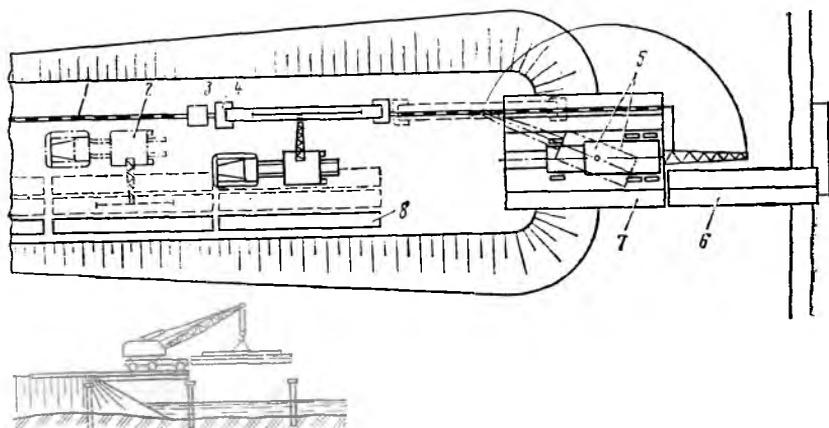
Схема монтажа пролетных строений «вперед себя»:
